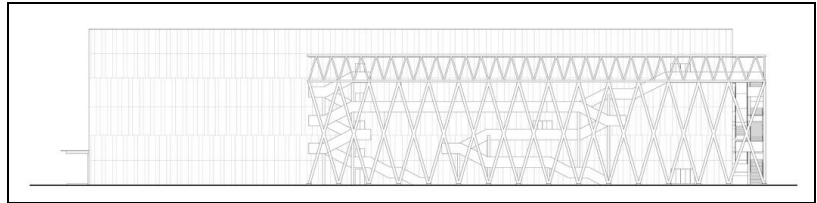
Façade Ouest de l'équipement, source : *archdaily.com
